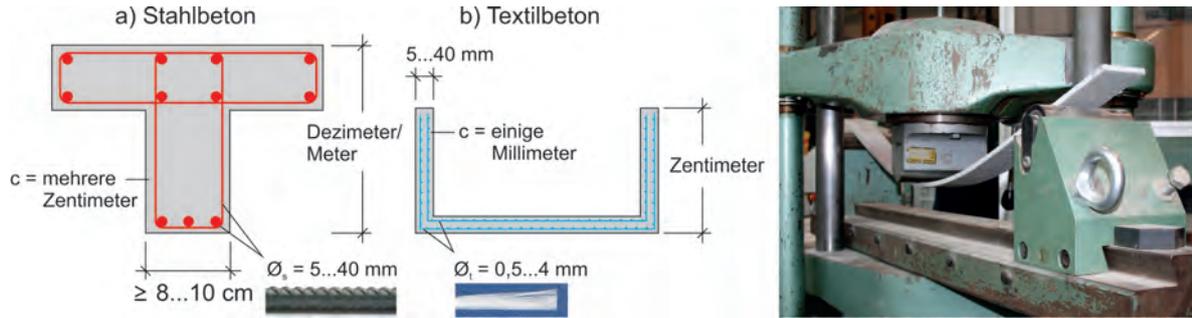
Textilbeton – ein leistungsfähiger Materialverbund⁶
